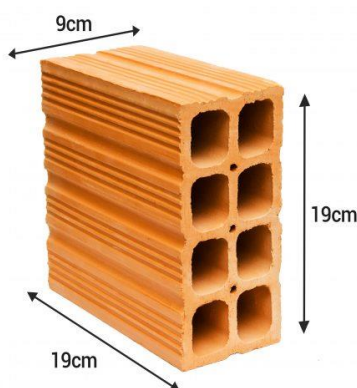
Dimensões do bloco cerâmico de vedação com furos na horizontal, de 9x19x19 cm, utilizados para construção da parede da fossa séptica de evapotranspiração.
